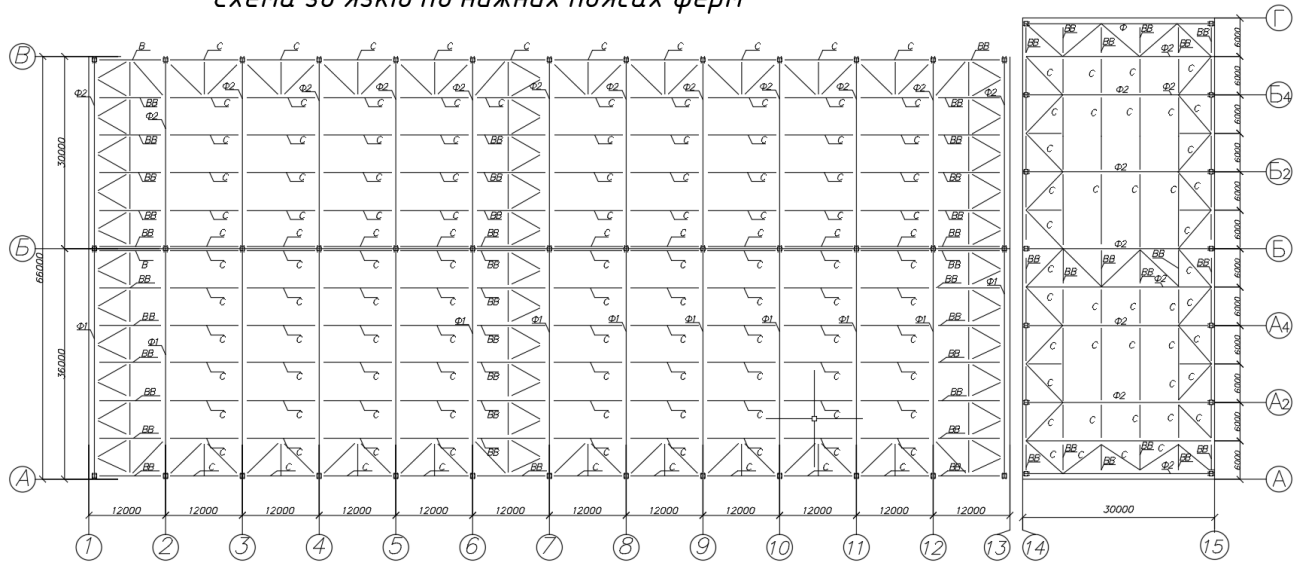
Схема зв'язків по нижніх поясах ферм
